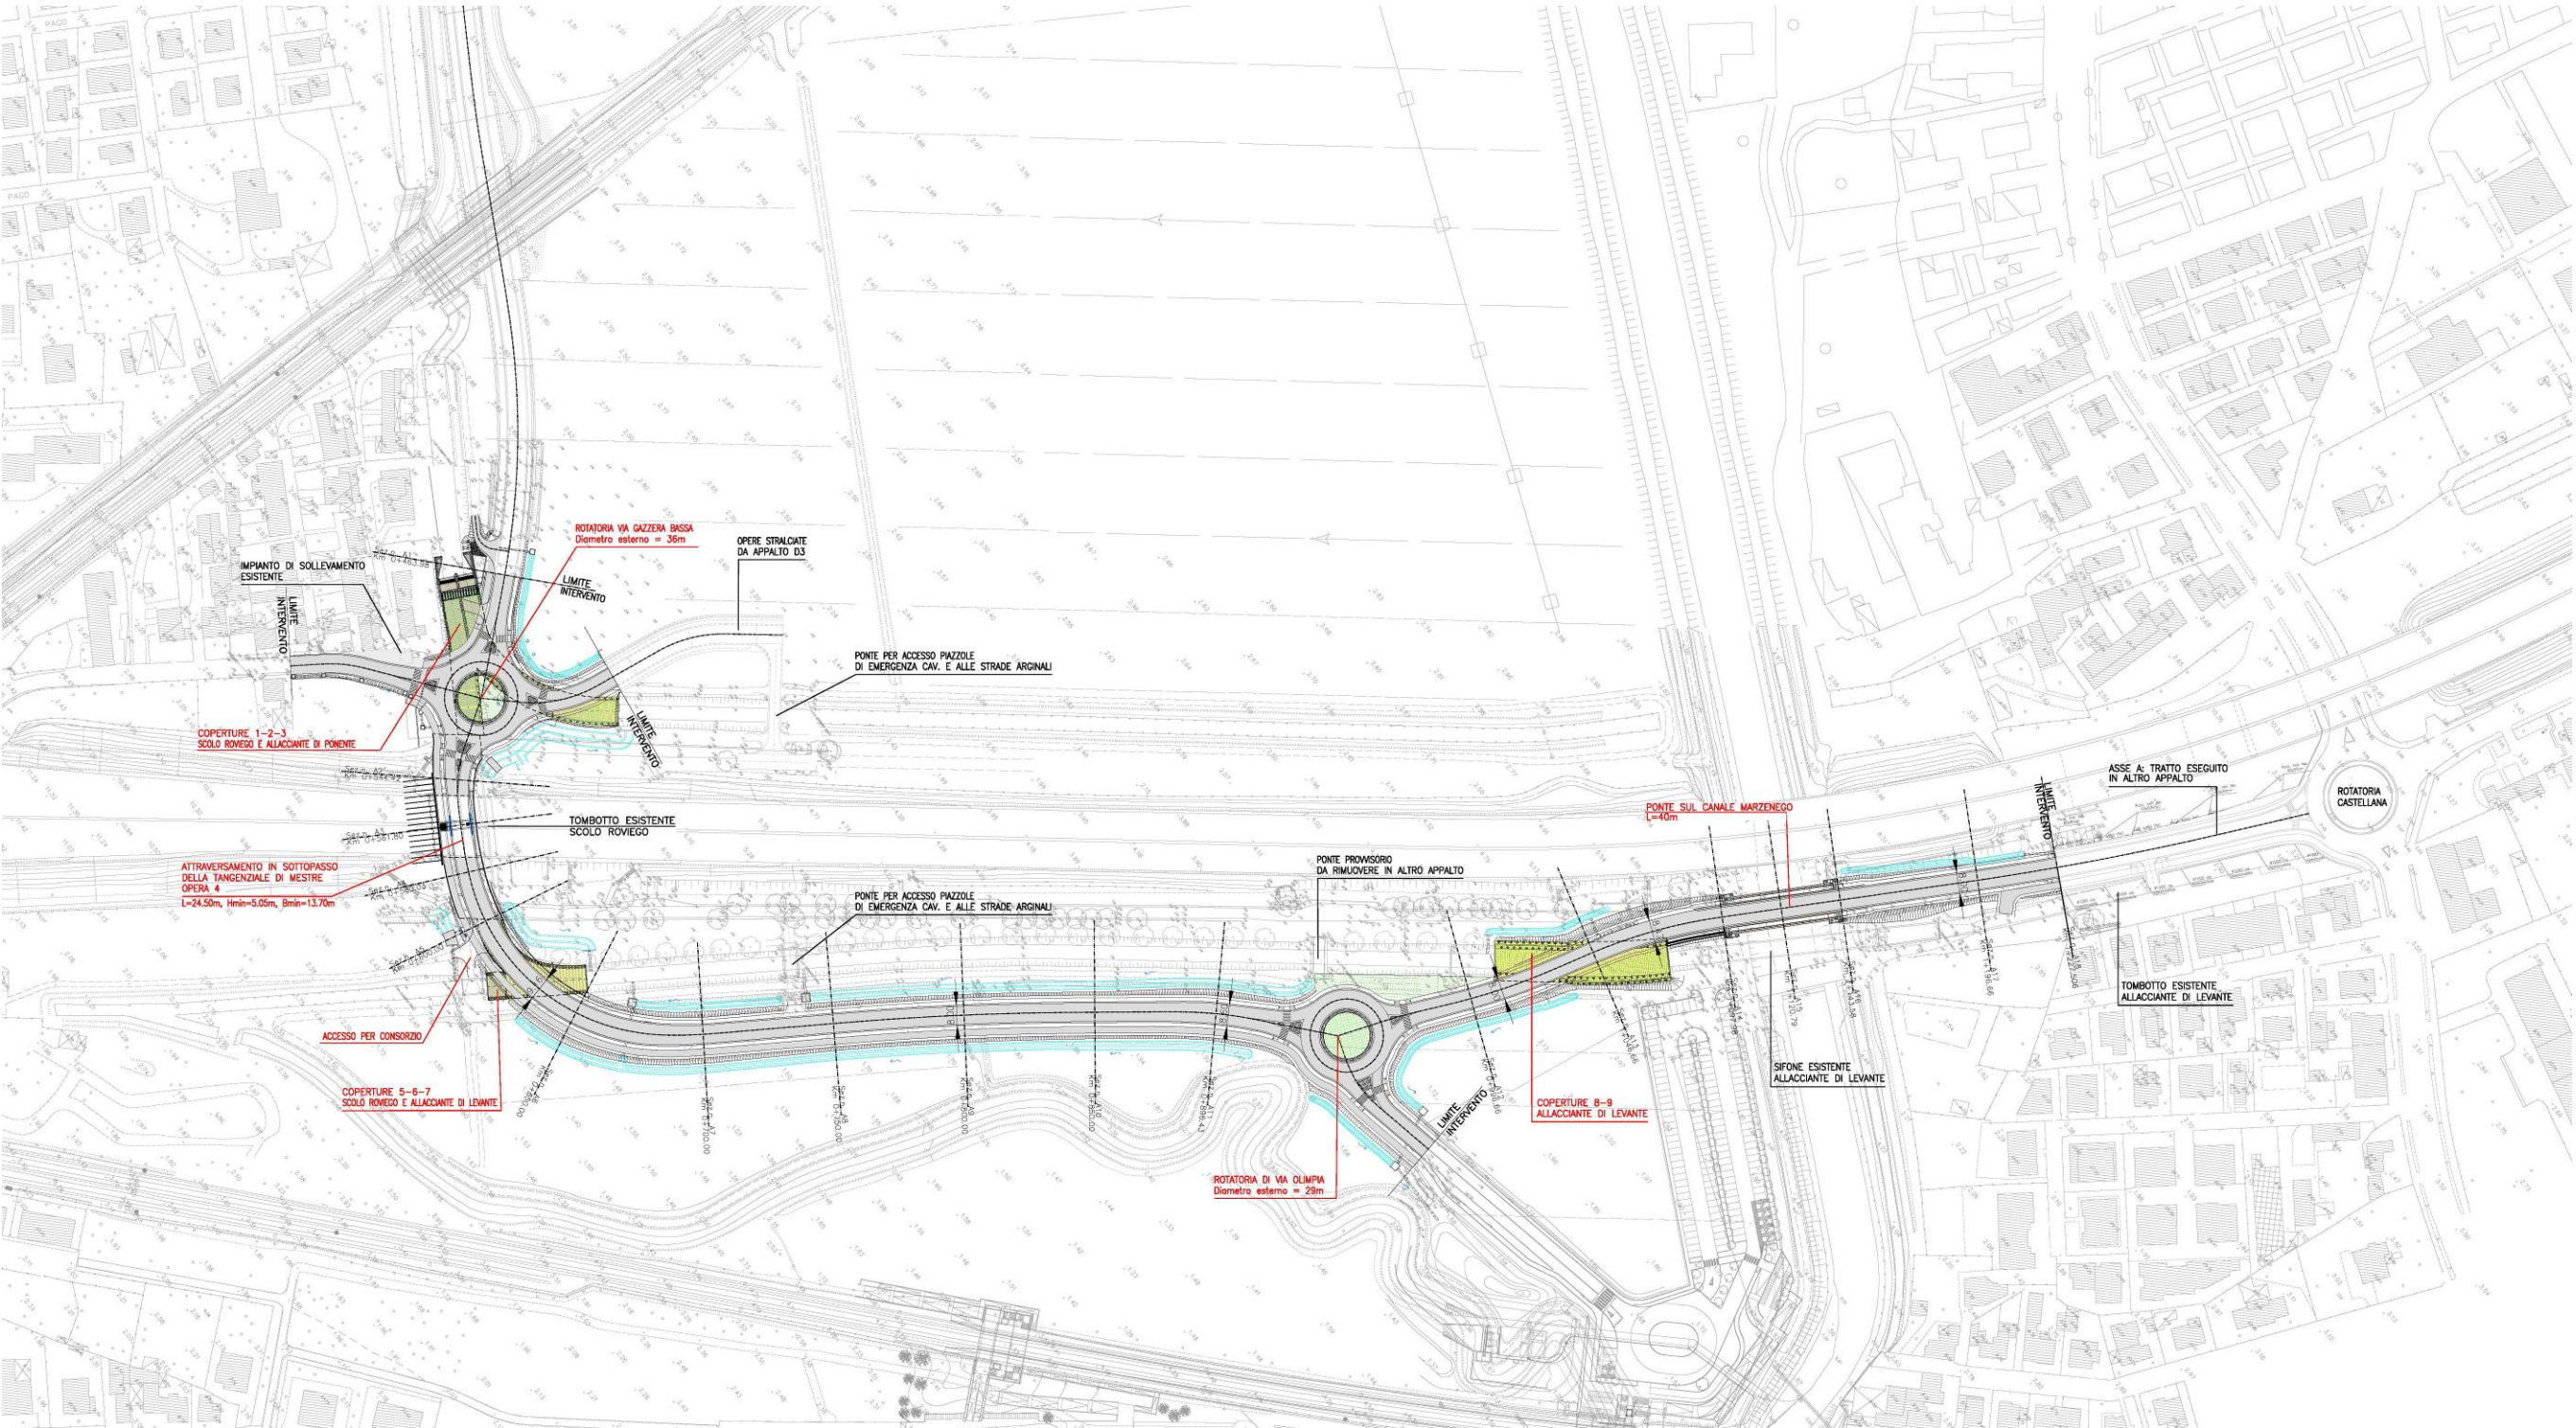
Intervento 1.09bis – Planimetria di progetto
